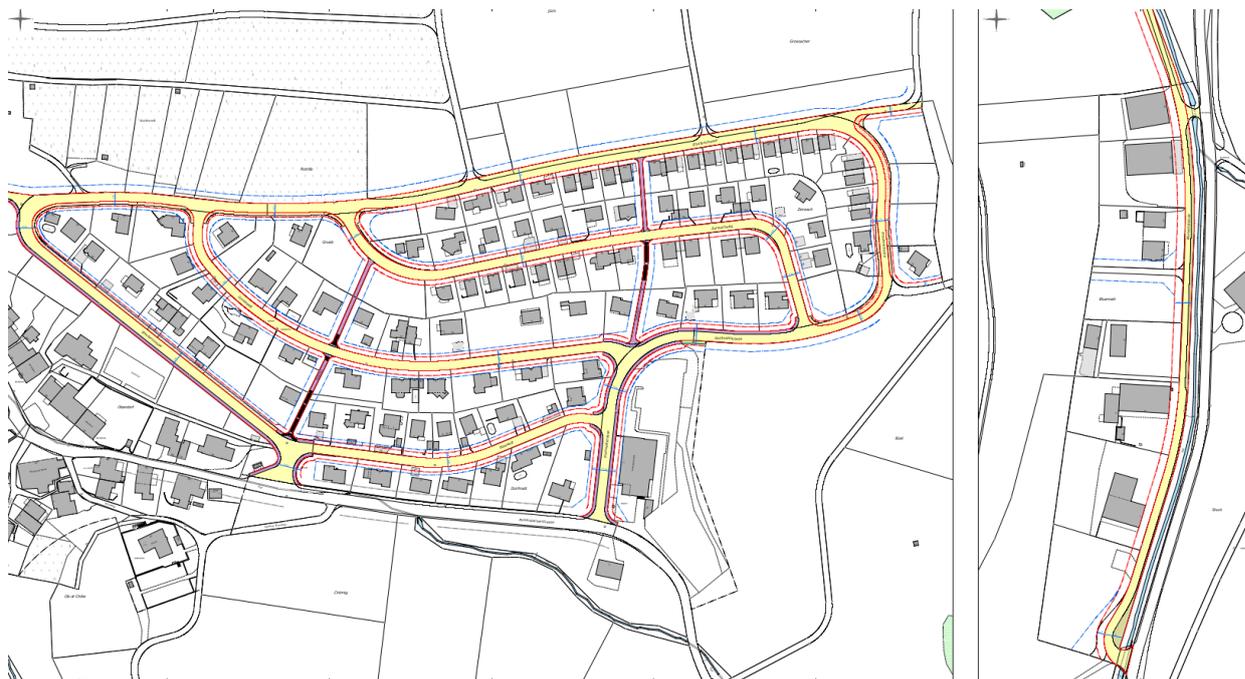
Ausschnitt Mutationsplan Teilrevision Bau- und Strassenlinien, Wintersingen
